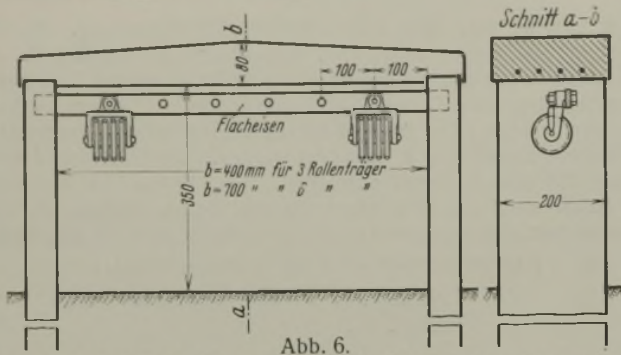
Eisenbetonständer für drei und mehr Drahtzugleitungen. (Bauart Roudolf.)
